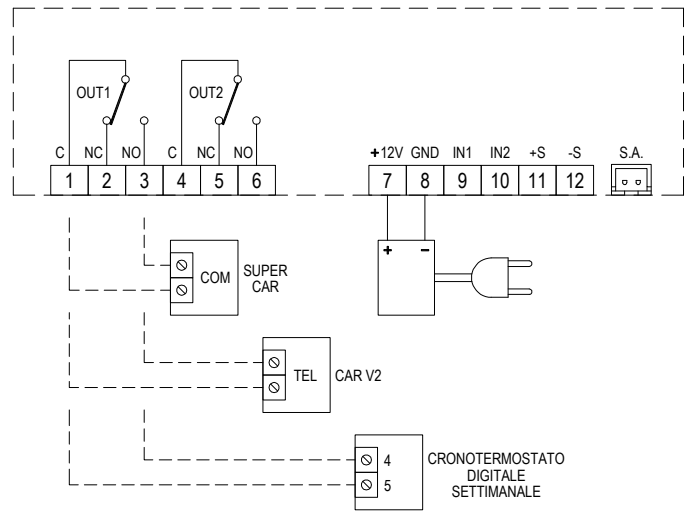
Esempio di collegamento ad una termoregolazione Immergas.
